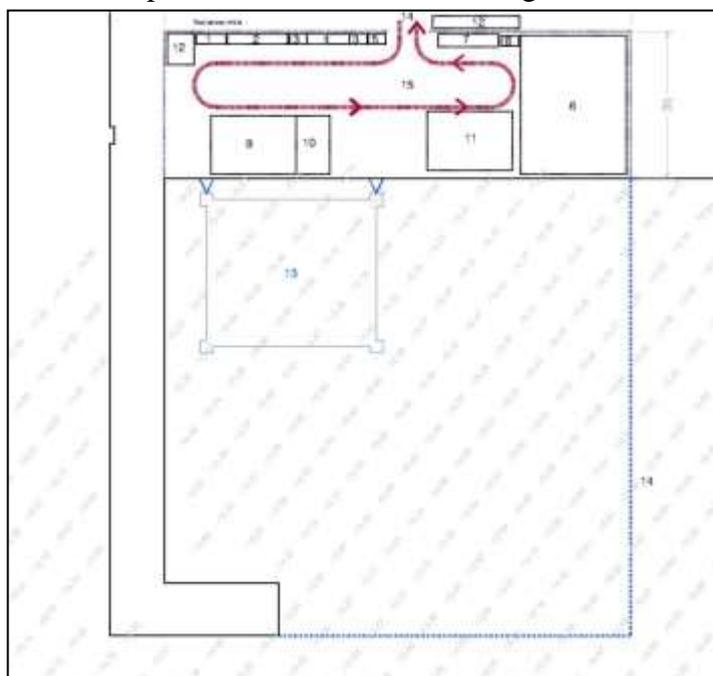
Area di cantiere per la prefabbricazione dei cassoni
